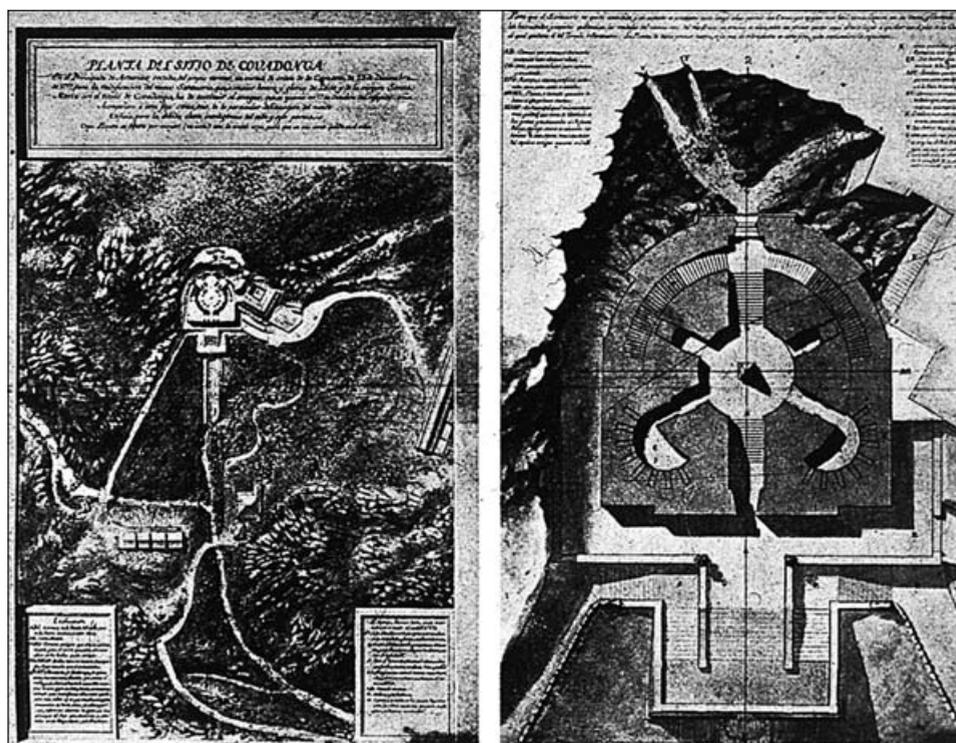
Ventura Rodríguez. Proyecto para la iglesia de la Colegiata de Covadonga, plano de situación y planta del primer piso, 1779.
